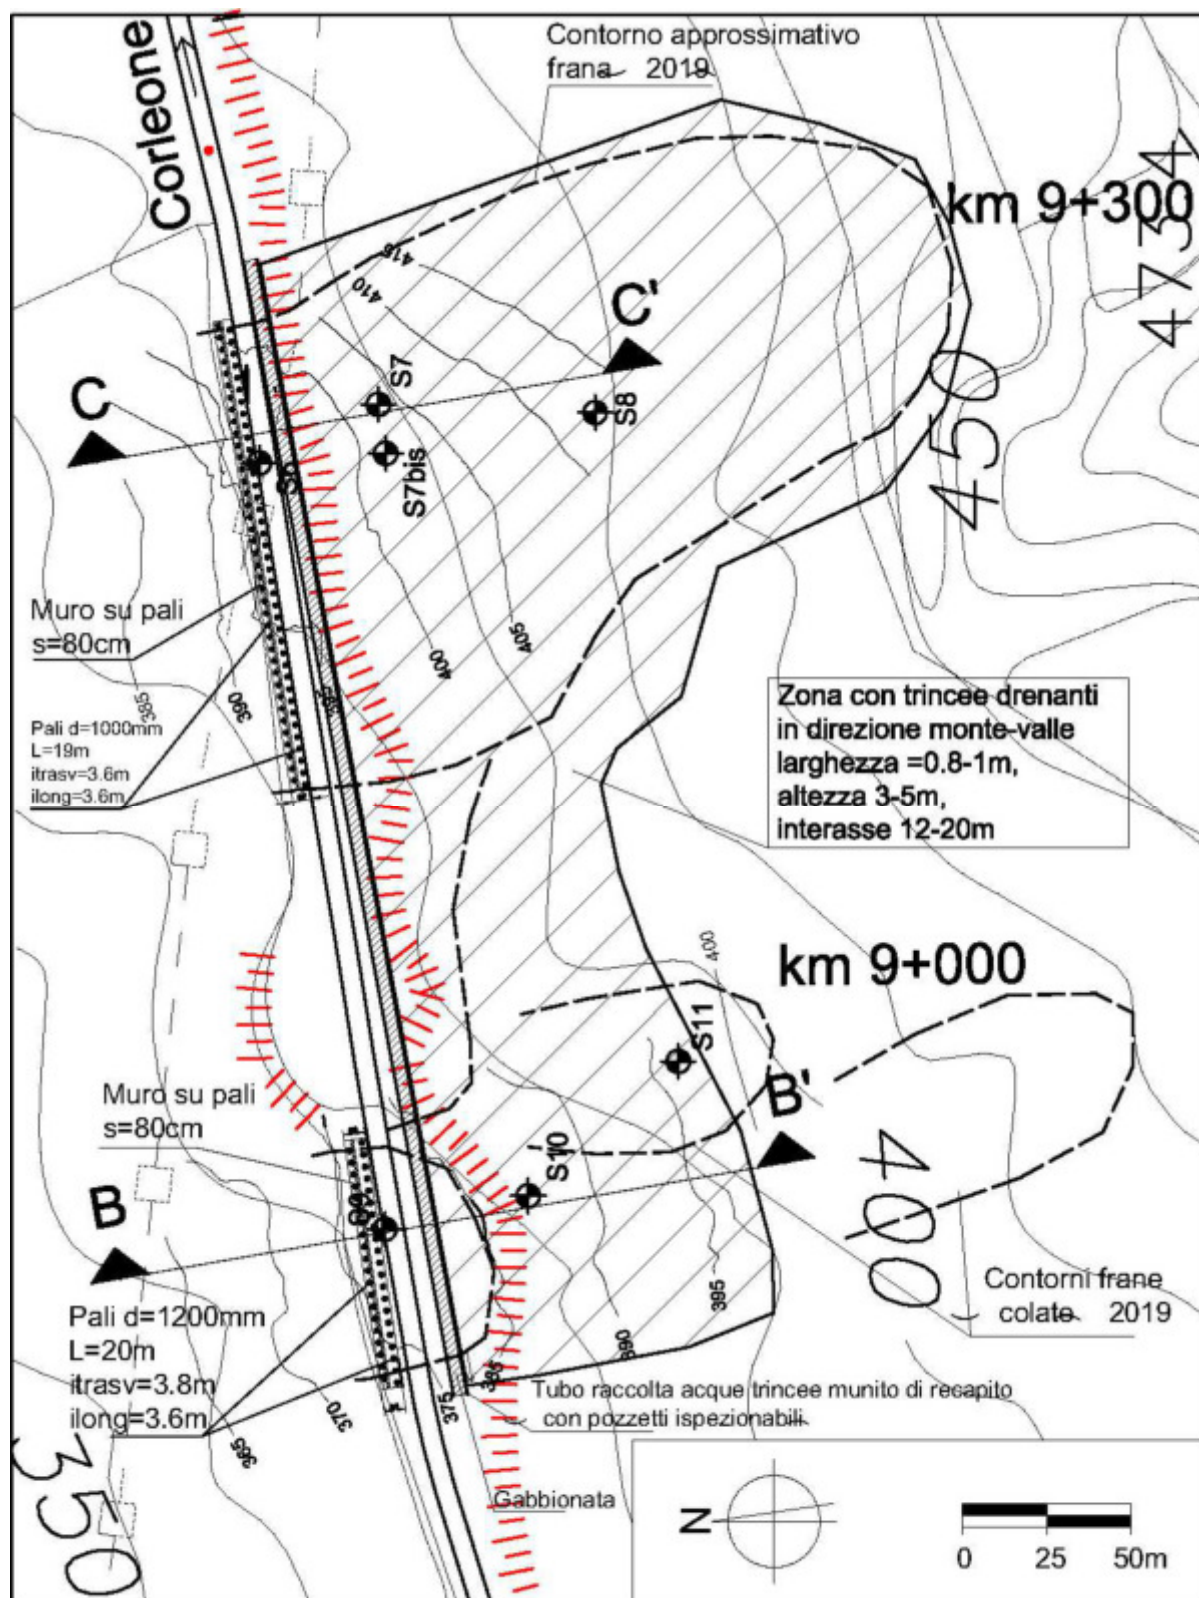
Dissesto dal km 9+000 al km 9+300. Planimetria schematica degli interventi da realizzare.
